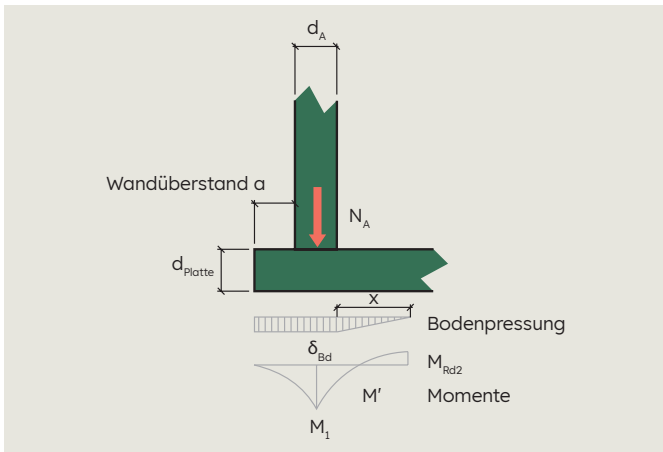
Darstellung Bemessungsansatz Außenwand auf einer Fundamentplatte
